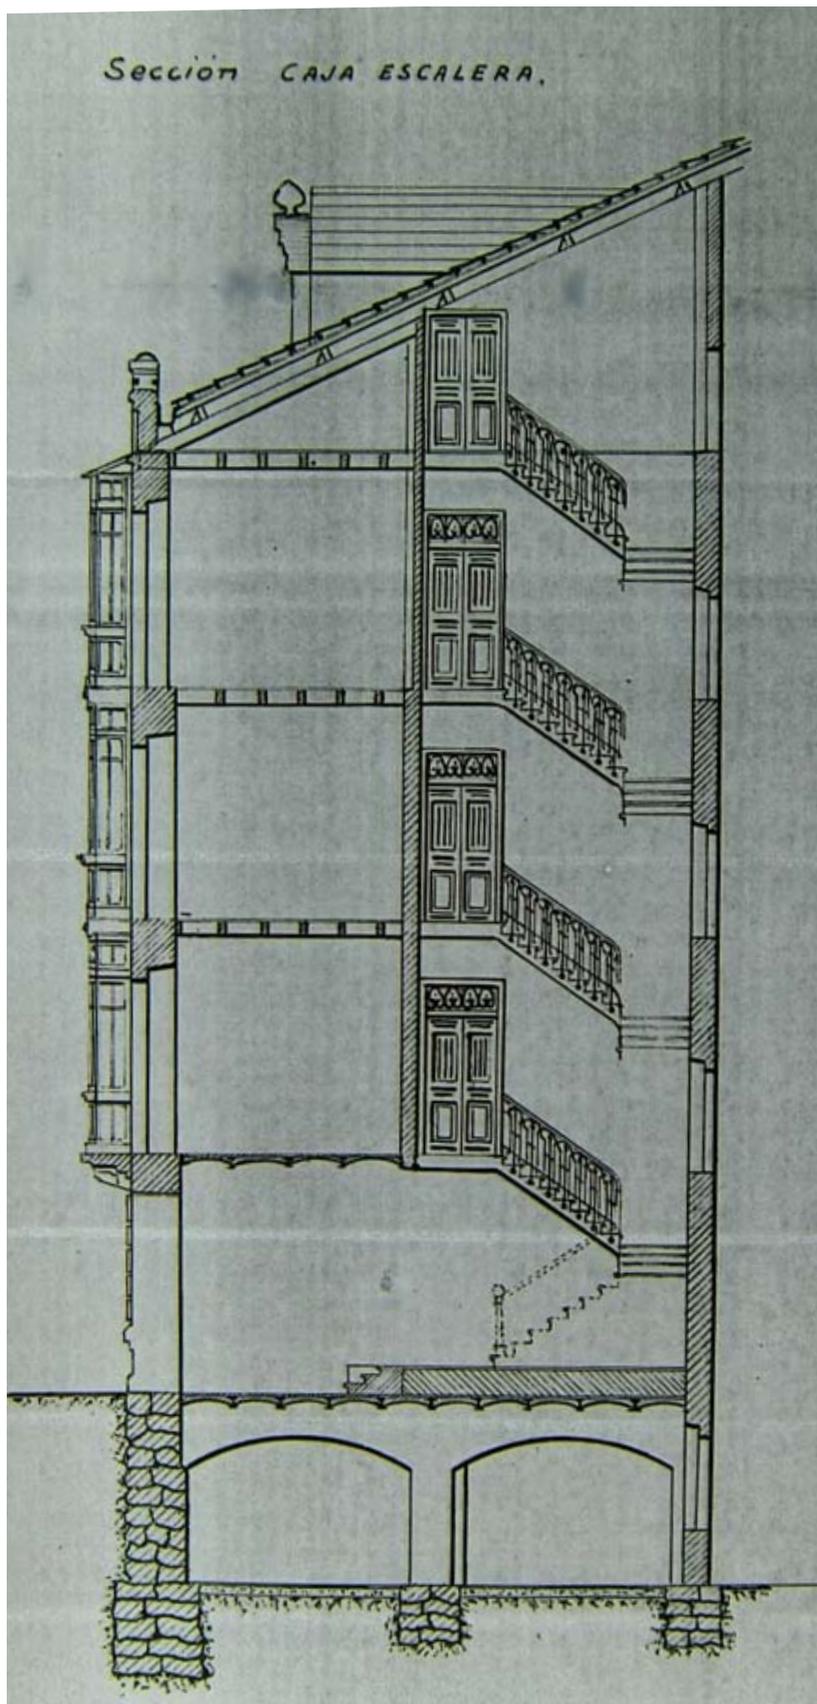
Sección transversal en la que pueden apreciarse la cimentación, el espesor de los muros maestros y la combinación de entramados metálicos y de madera. Maestro de obras Benigno Rodríguez.
